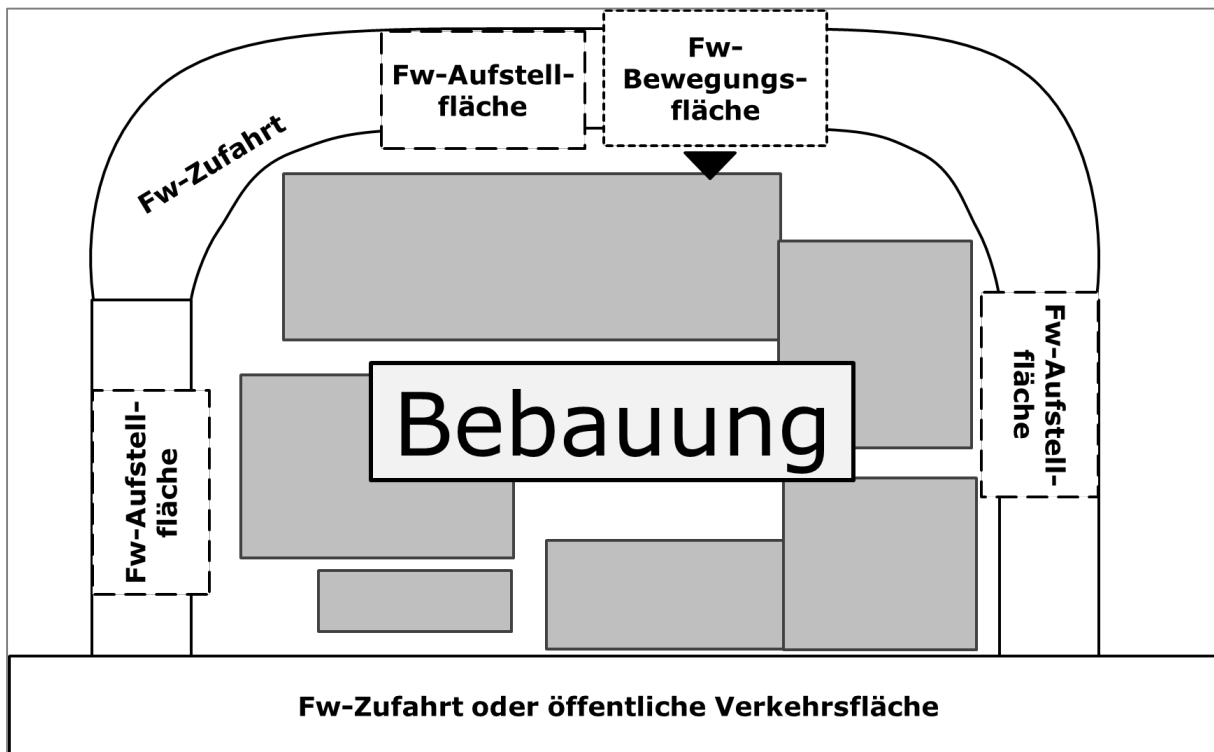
Feuerwehrebewegungsflächen und Feuerwehraufstellflächen bei einer Umfahrungssituation einer Feuerwehzufahrt
